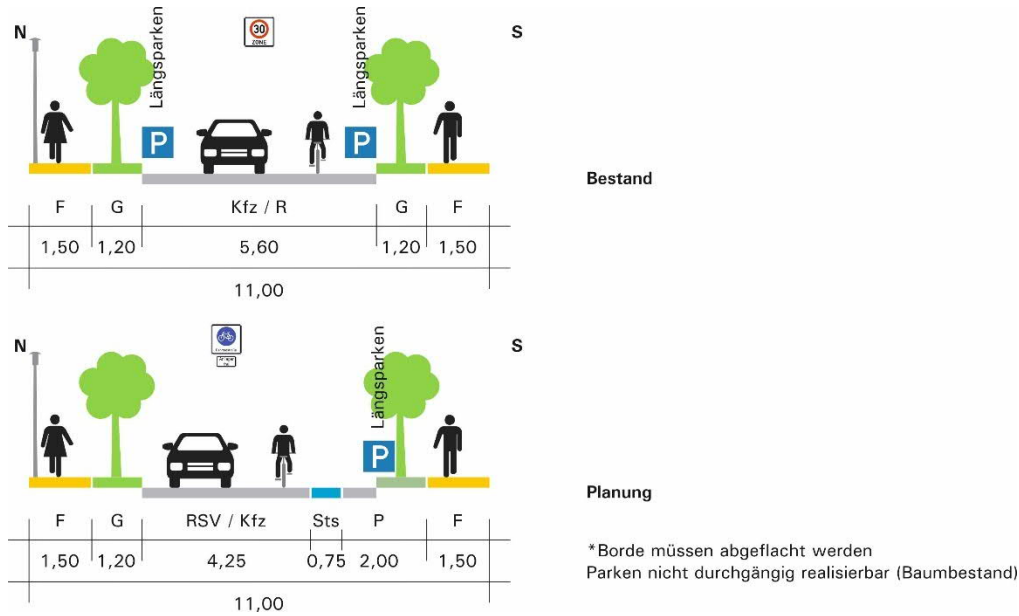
Querschnitt Abschnitt Schimmelmannstraße (A-13; Bestand und Planung)
